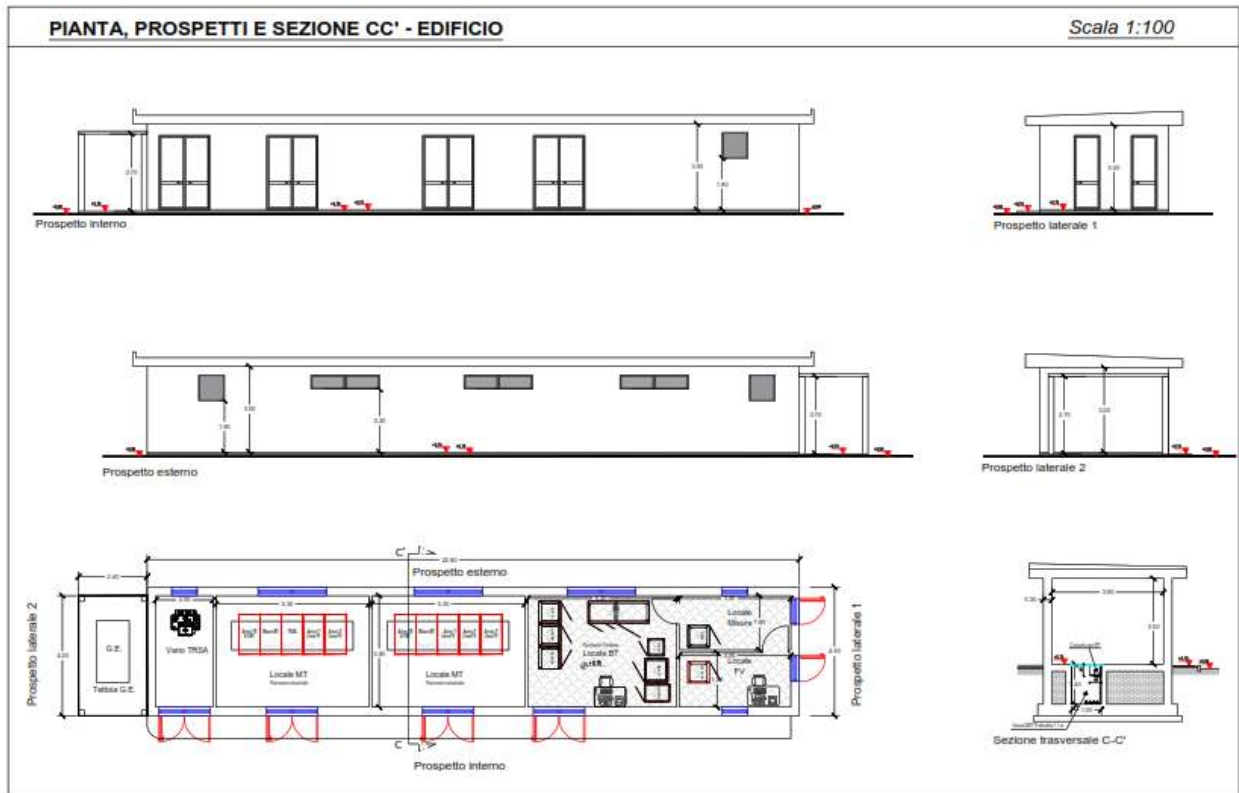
Estratto prospetti e sezioni planimetria sottostazione (area utente)
